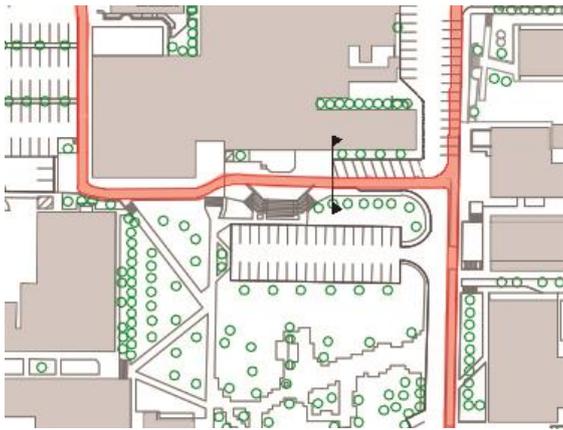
Indicação do Corte 6, planta da área do CAASO (imagem do autor).
